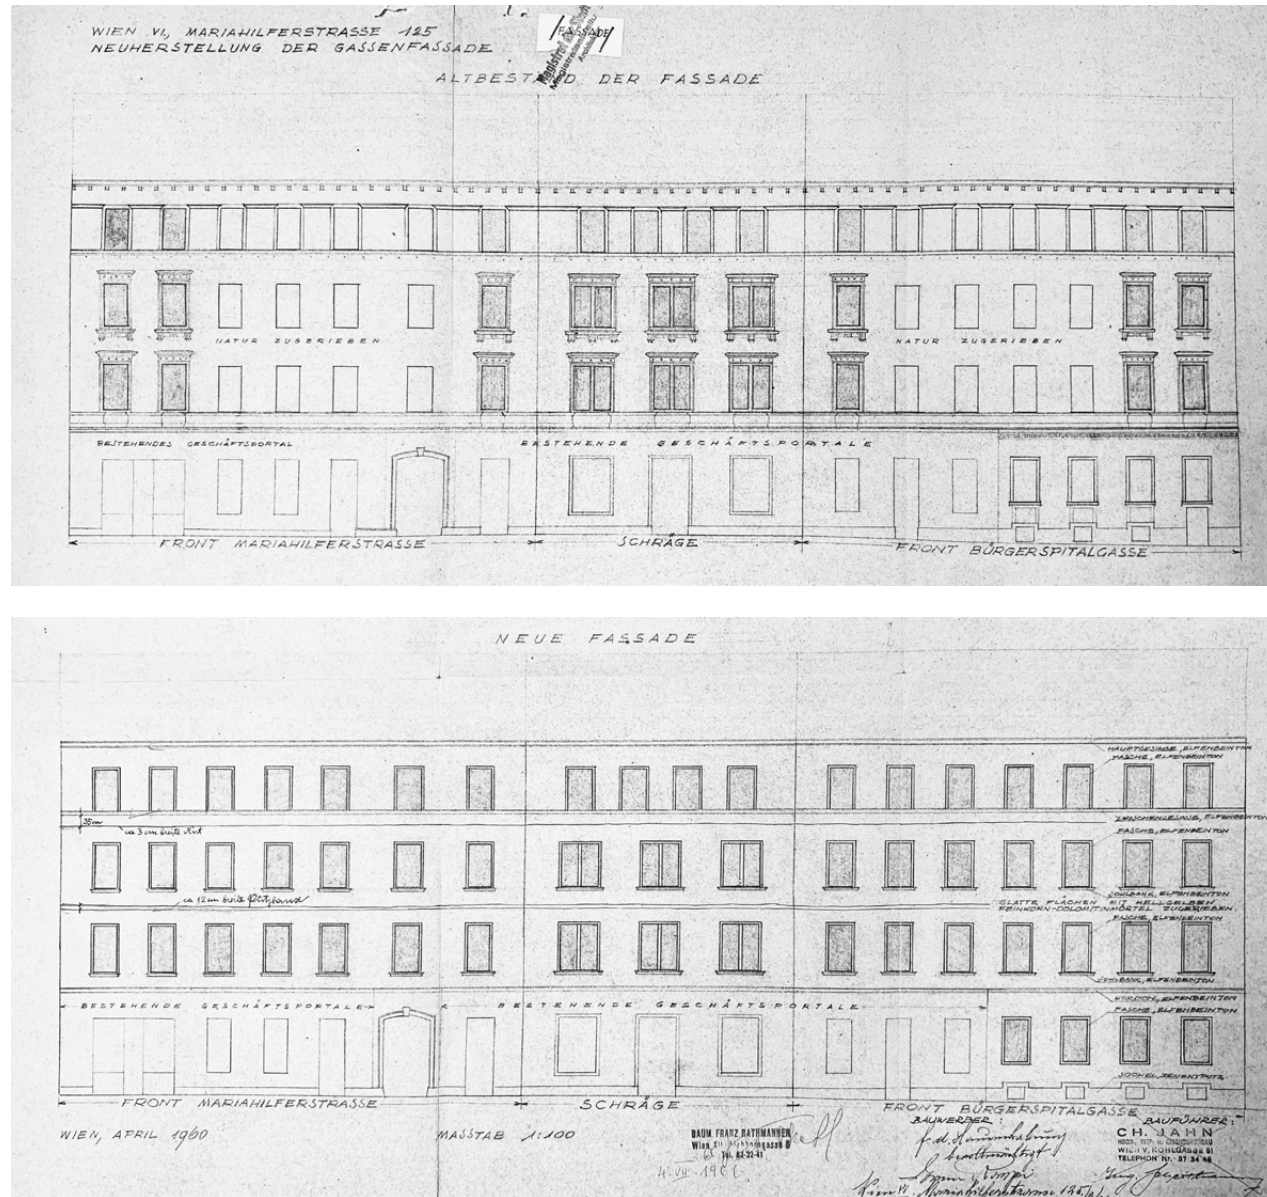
Planmaterial MA 37, Entschmückung der Fassade (Bestandsgebäude Entwurf)
